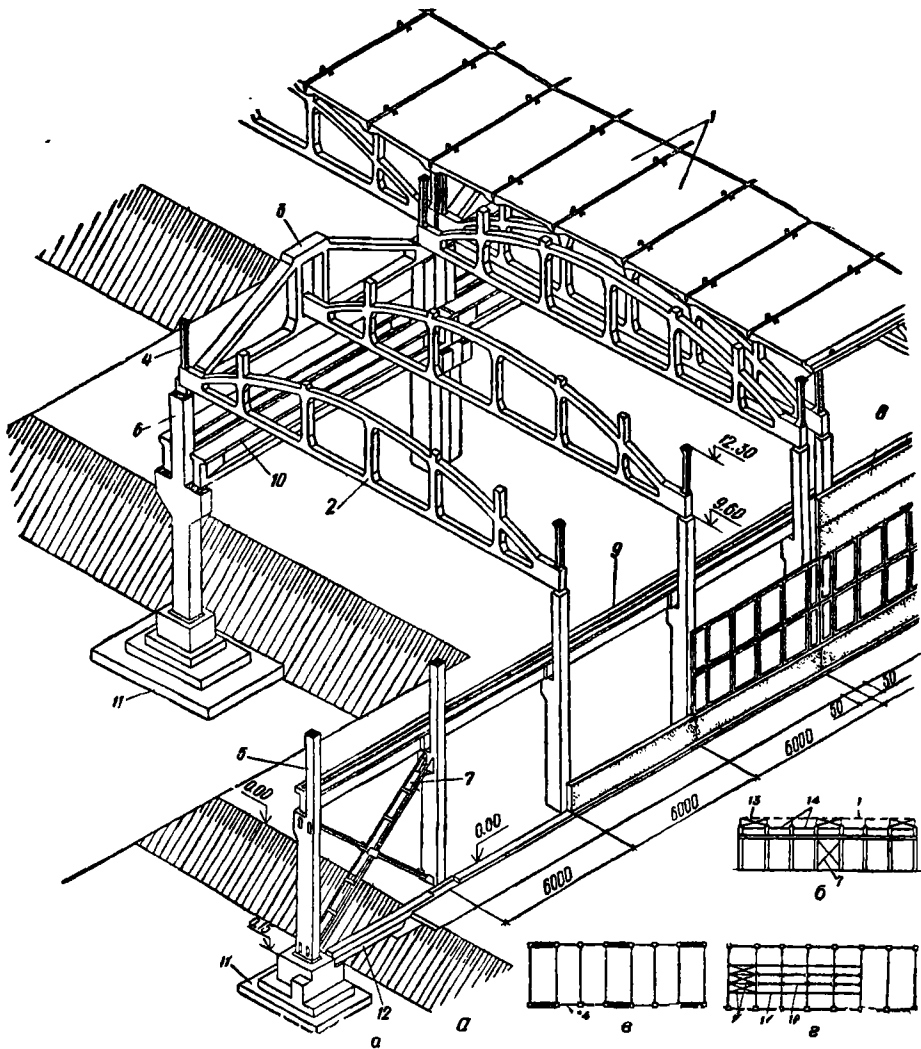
Збірний залізобетонний каркас одноповерхової промислової будівлі і схеми в'язей: а — загальний вигляд каркаса будівлі; б — встановлення вертикальних в'язей; в — те саме, горизонтальних розпорок; г — те саме, горизонтальних діафрагм; 1 — плити покриття 3 × 6 м; 2 — безкосцева ферма $l = 18$ м під плоску покрівлю; 3 — підкровоквяна ферма $l = 12$ м; 4 — металевий стійак; 5 — колона крайнього ряду (крок 12 м); 6 — колона середнього ряду (крок 12 м); 7 — хрестові в'язі по колонах з кутикової сталі; 8 — стінові панелі $l = 6$ м; 9 — підкранова балка $l = 6$ м і кранова колія; 10 — підкранова балка $l = 12$ м; 11 — монолітний фундамент під колону; 12 — фундаментна балка $l = 6$ м; 13 — ферма з кутикової сталі; 14 — сталеві розпірки; 15 — в'язеві ферми в площині покриття; 16 — сталеві тяжі
